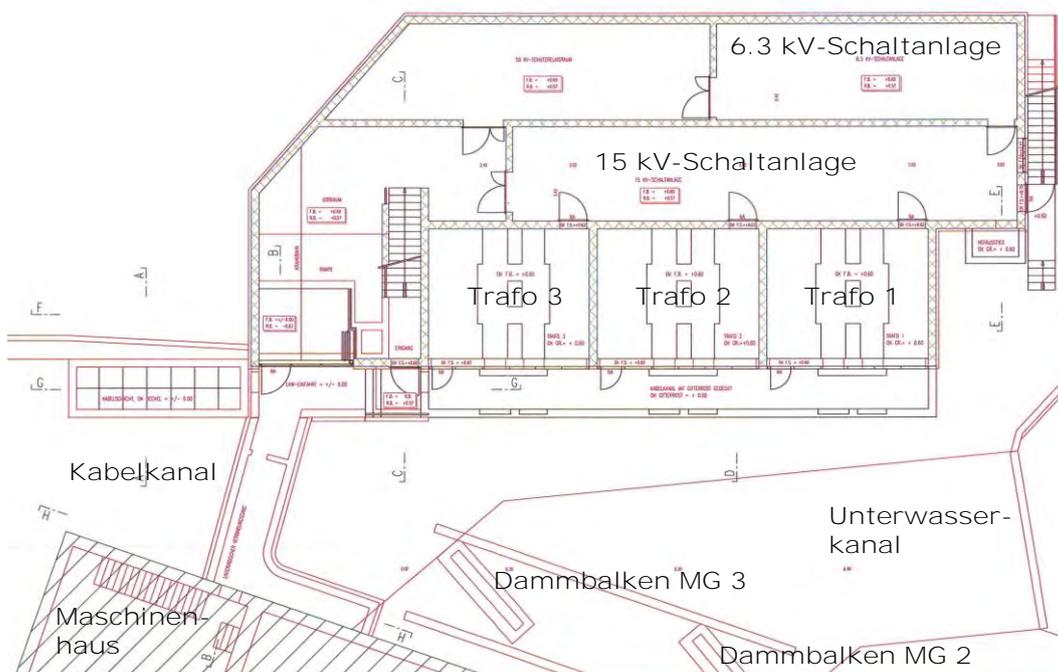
Grundriss der Trafo- und Schaltanlage mit unterirdischem Kabelkanal zum Maschinenhaus
